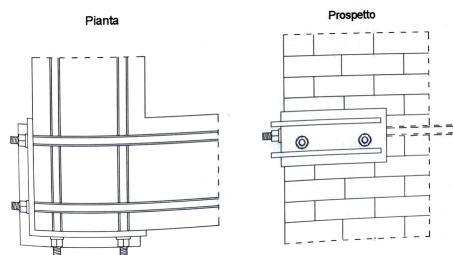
Capochiave d'angolo in pianta e prospetto.
